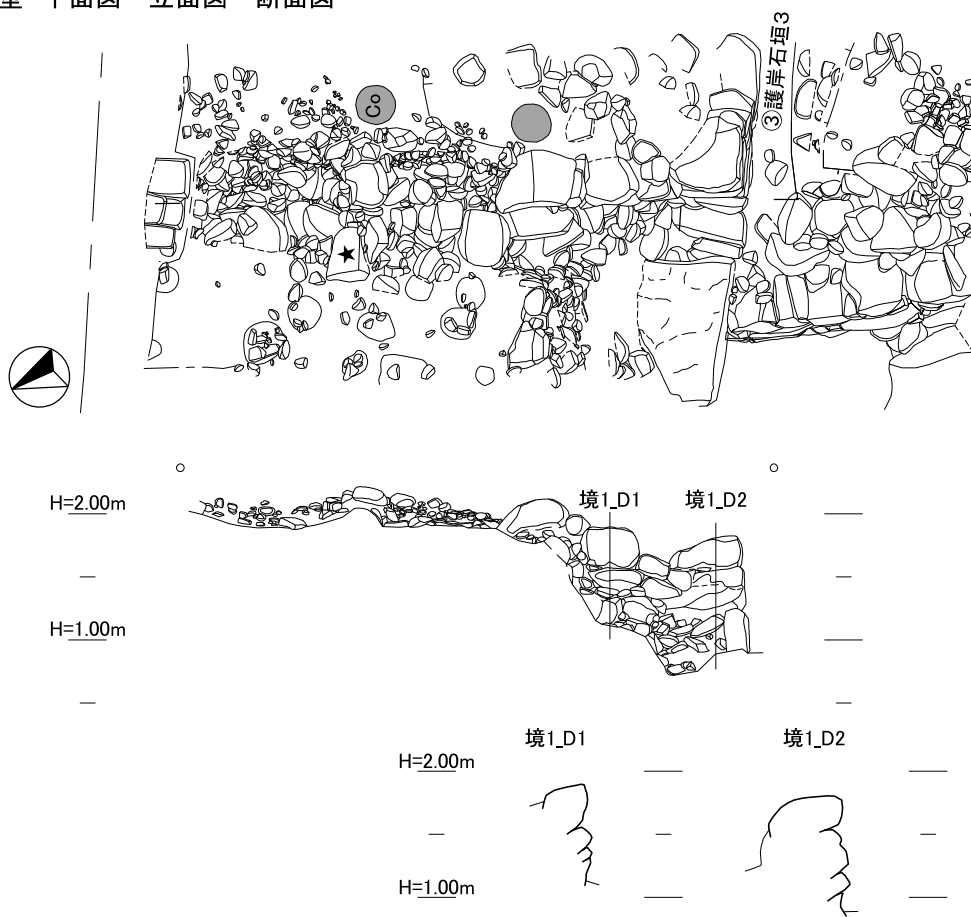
江戸町側 護岸石垣7東 立面图・立面图・断面图 (S=1/60)
